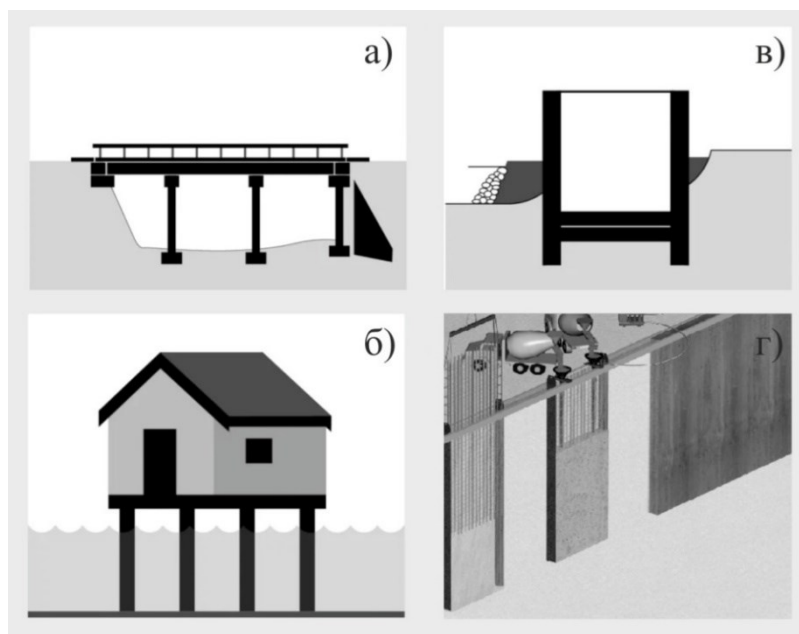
Основные типы фундаментов глубокого заложения: а, б – глубокие опоры (набивные столбы); в – колодцы (кессоны); г – стена в грунте
